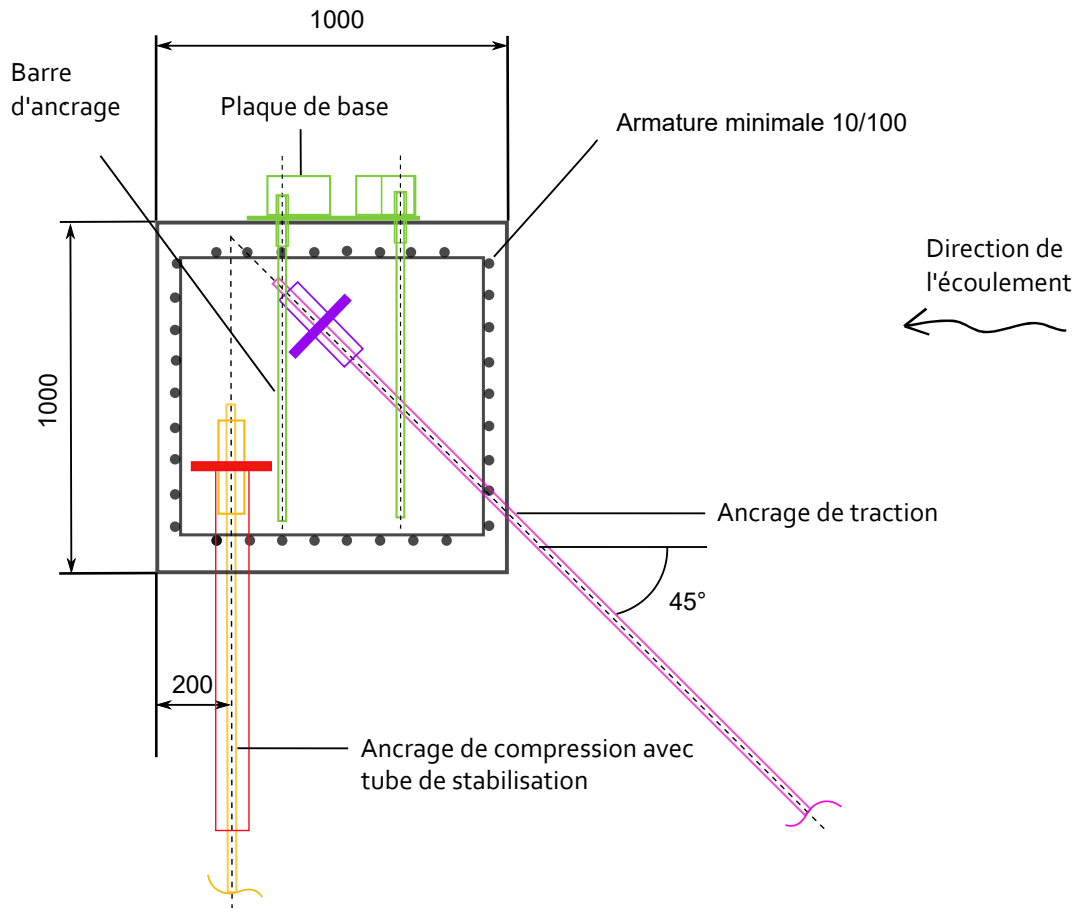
Vue latérale d'une fondation en béton armé avec une barre de pression et deux barres de traction, d'après [15].
